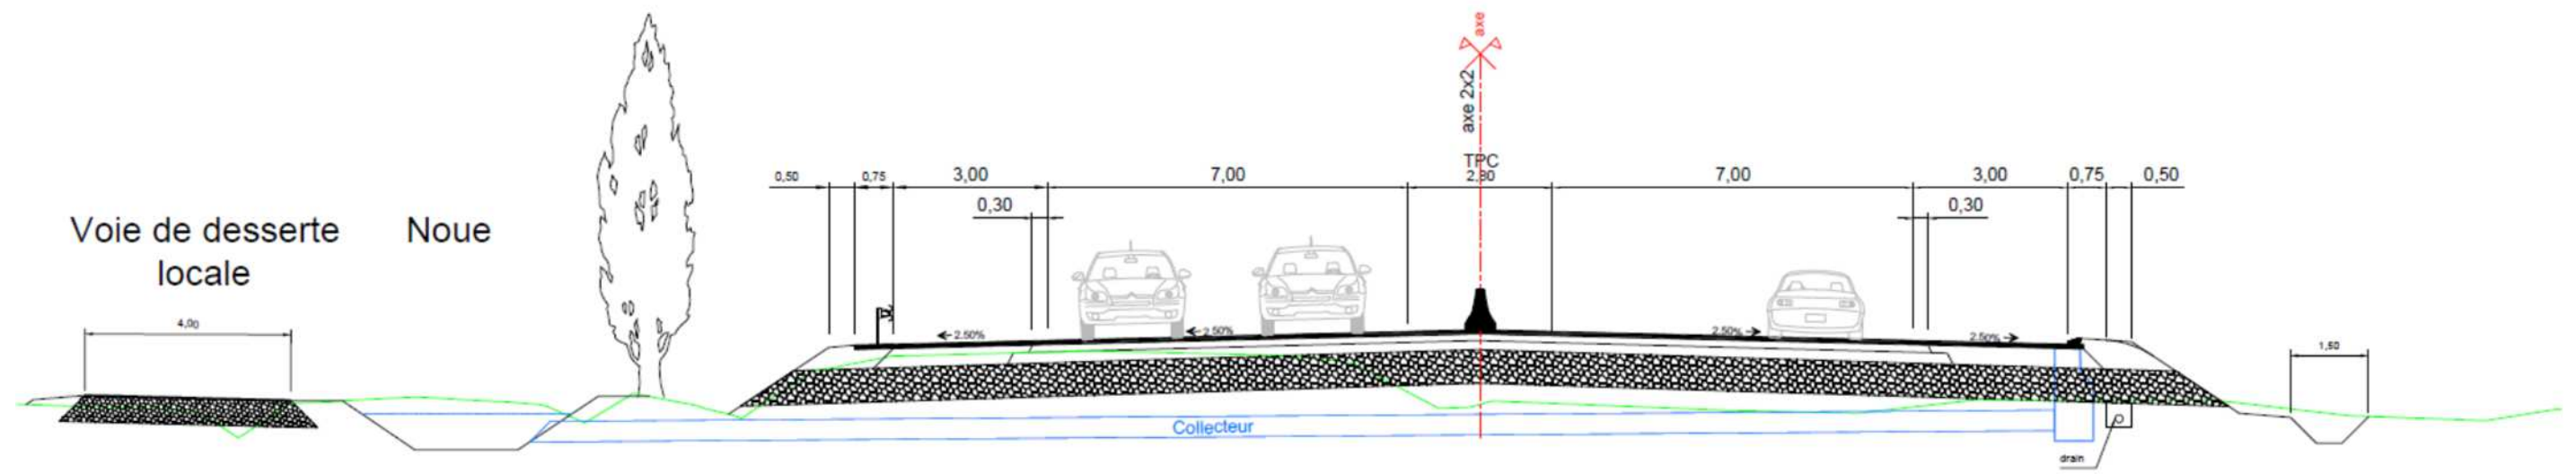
Profil en travers type de la section « Tournebride » - « Viâis » (secteur « Malabrit »)
